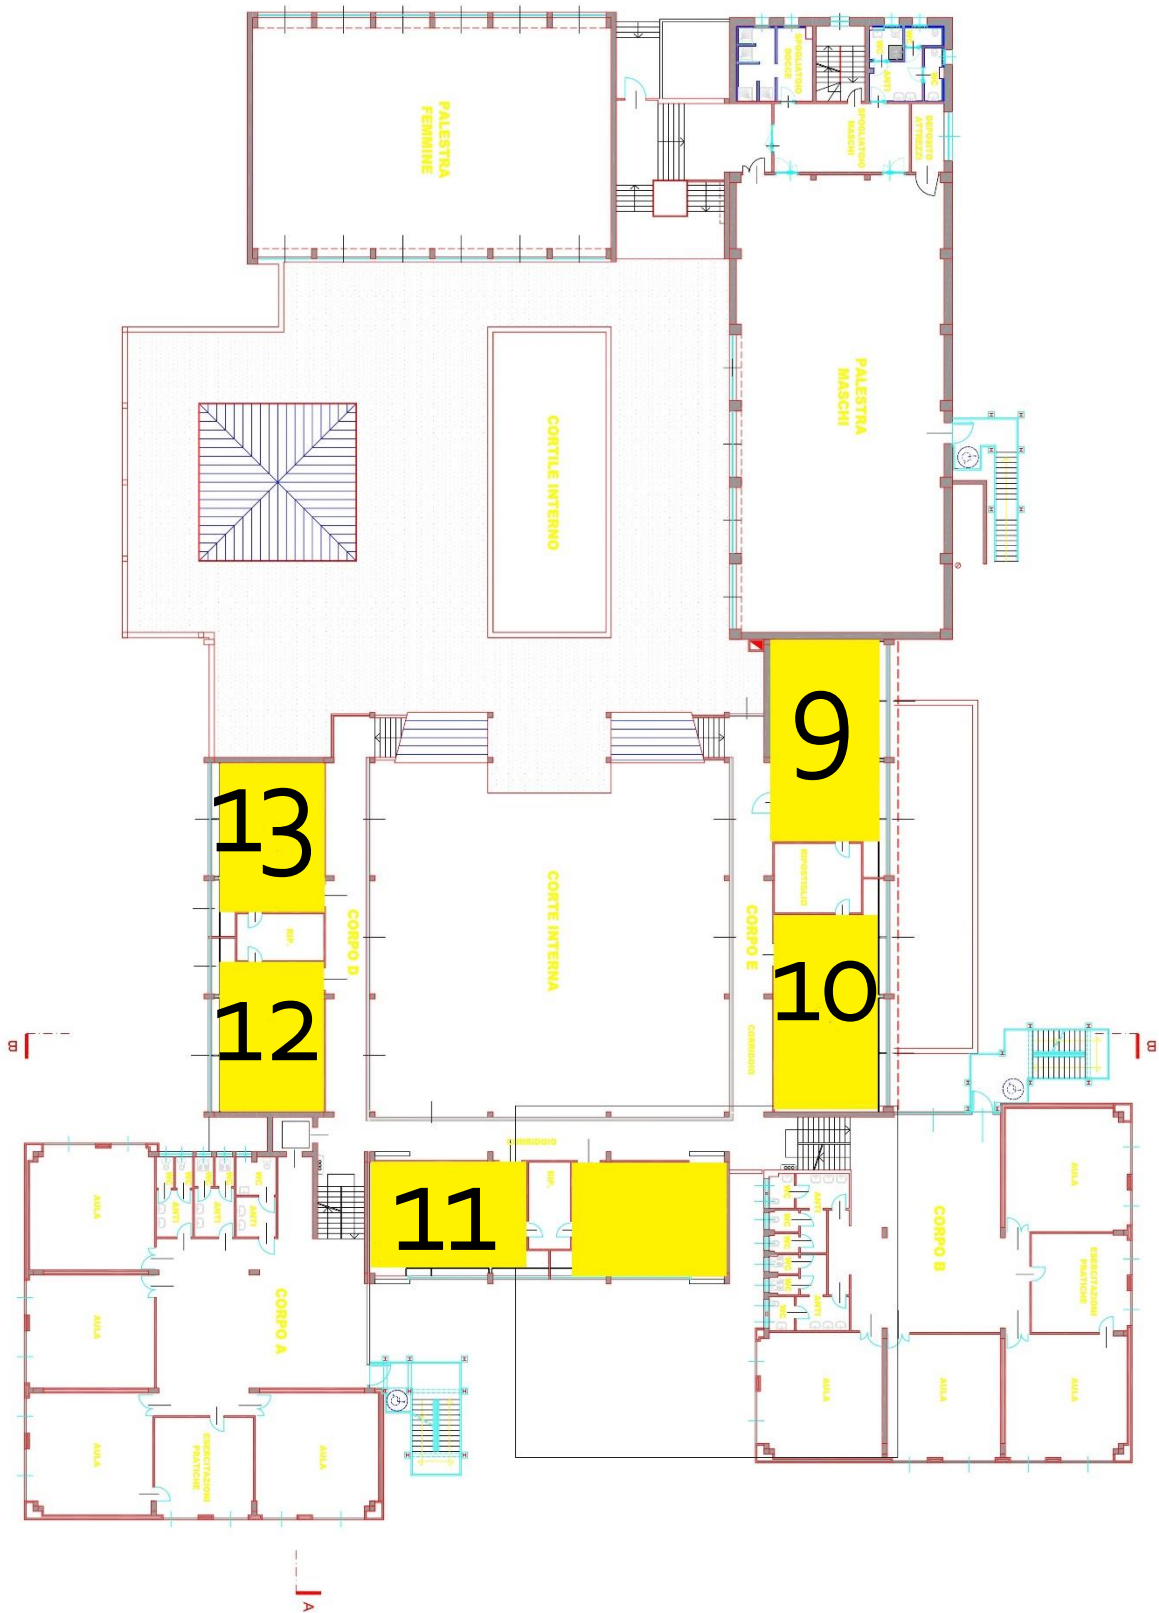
Planimetria primo piano della scuola secondaria di I grado di Maniago.
